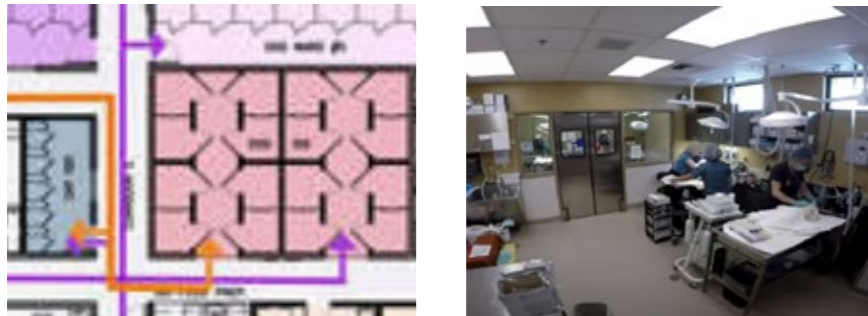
Zoning Palm Springs Animal Shelter (sumber: archdaily)
